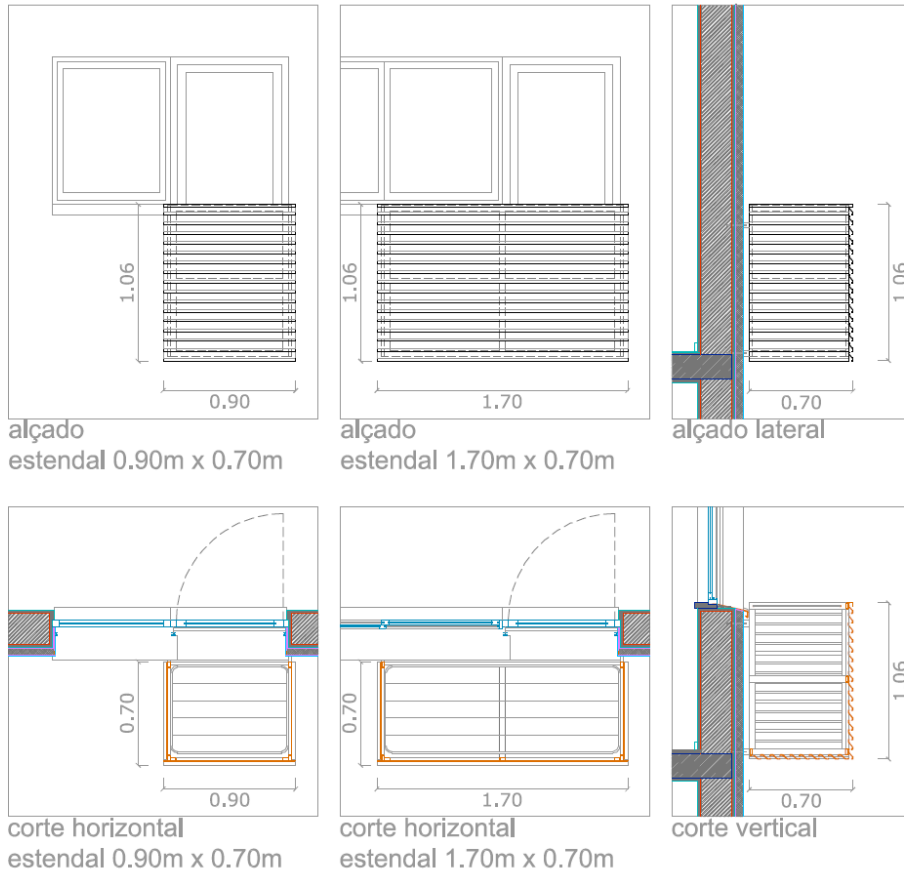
Proposta de varanda/estendal. Alçados, plantas e perfis (escala 1/50).
